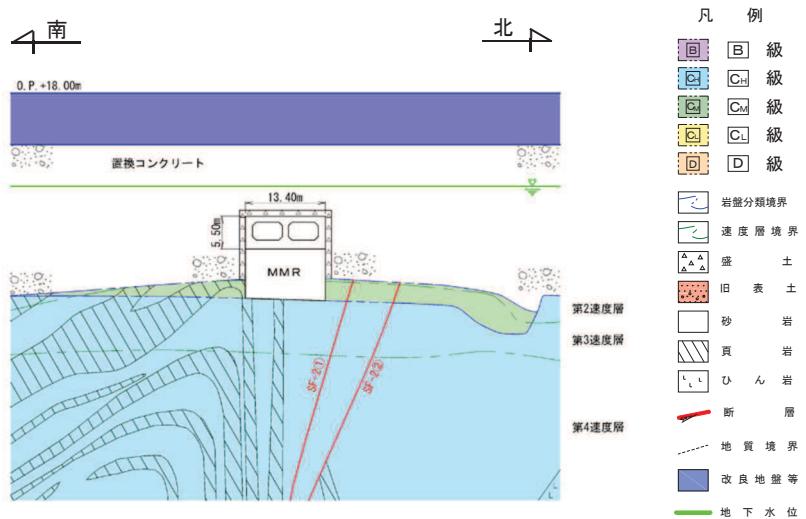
取水路（標準部）地質断面図（断面④：直線部）
